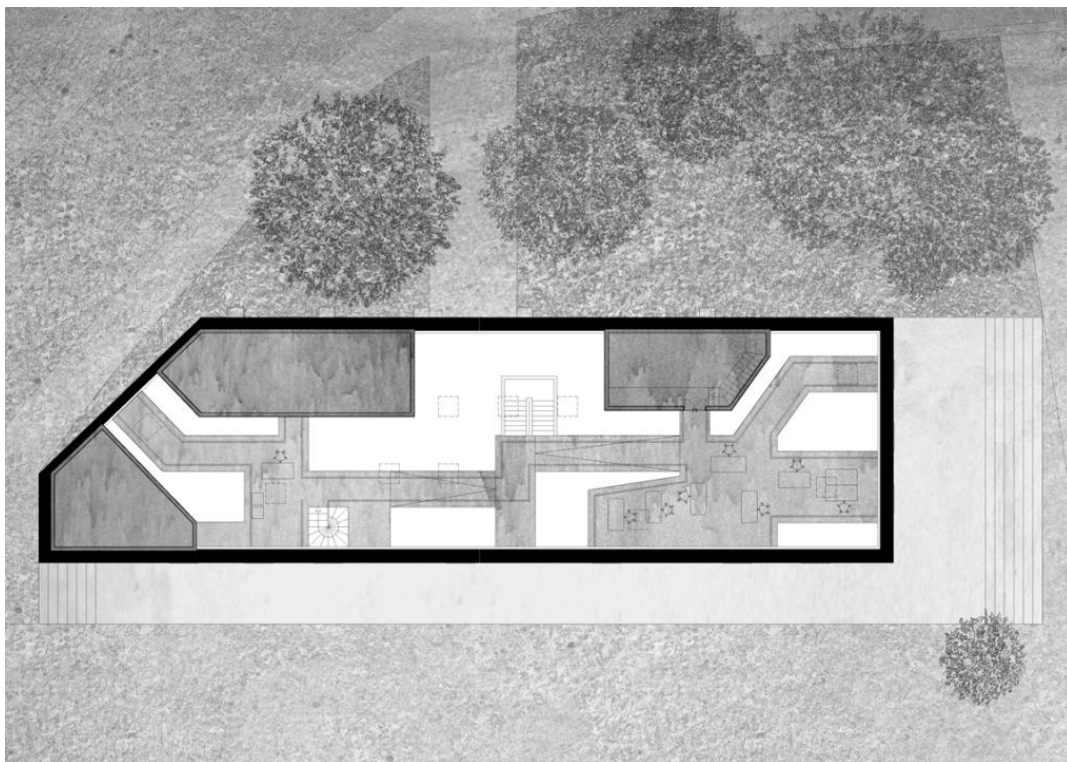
Casa dos Cubos, planta do piso térreo (EMBAIXADA arquitectura, Tomar, Portugal)
